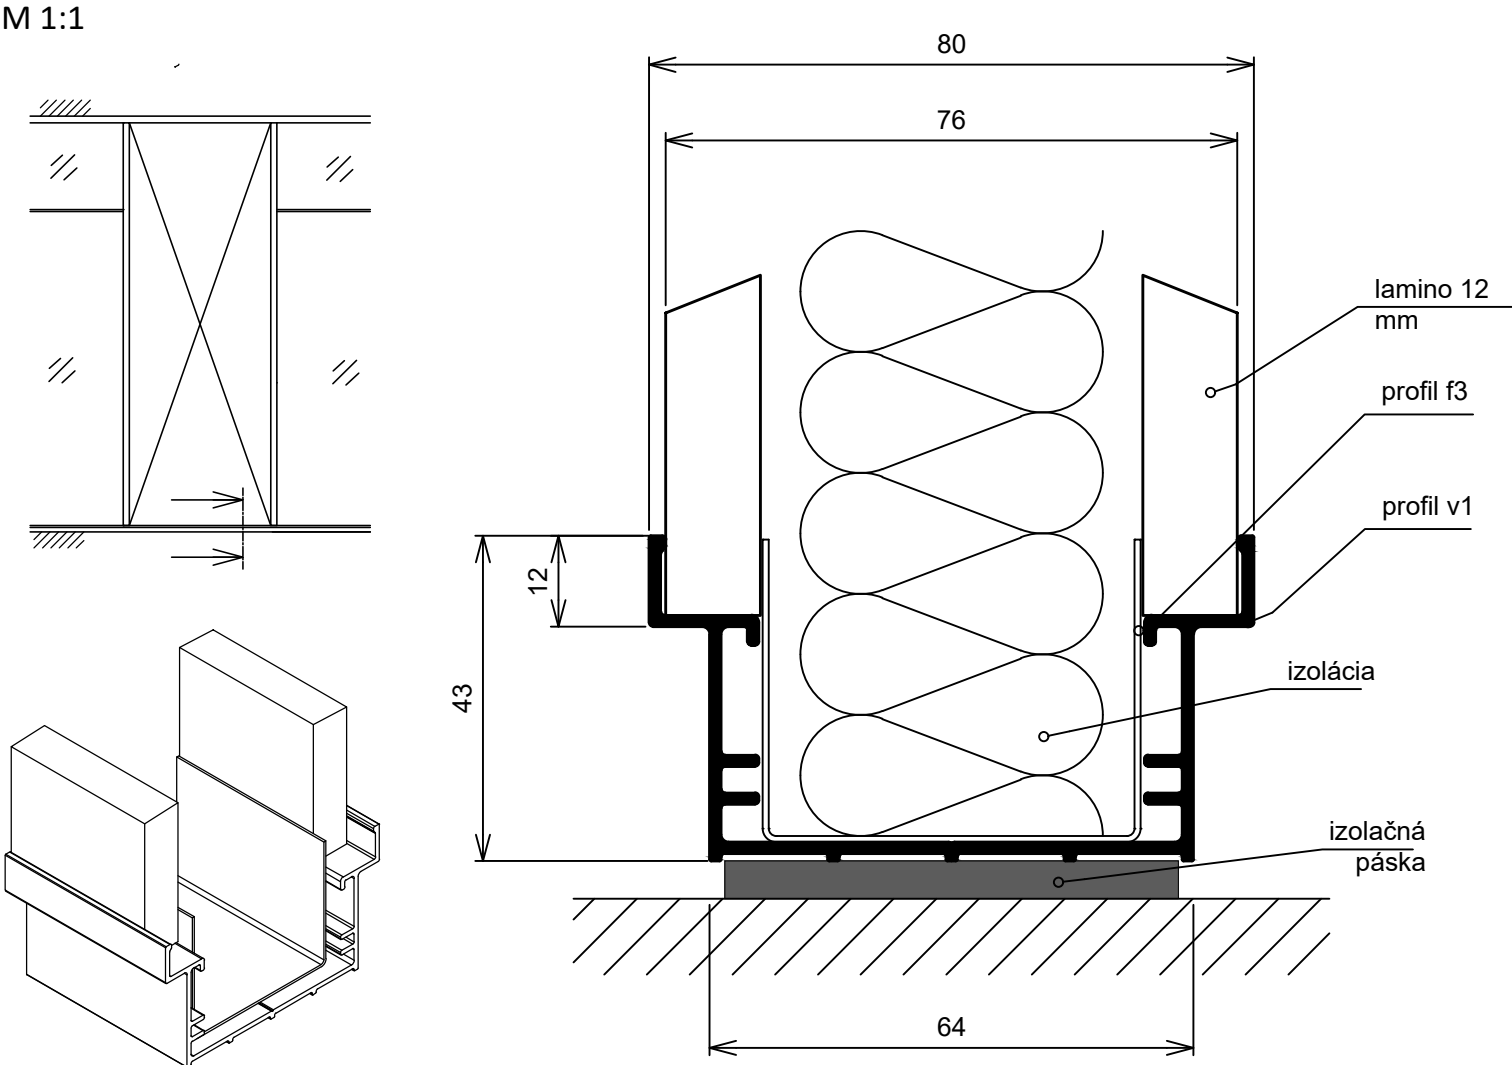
DETAIL NAPOJENIA PRESKLENEJ PRIEČKY V MIESTE OSTENIA
